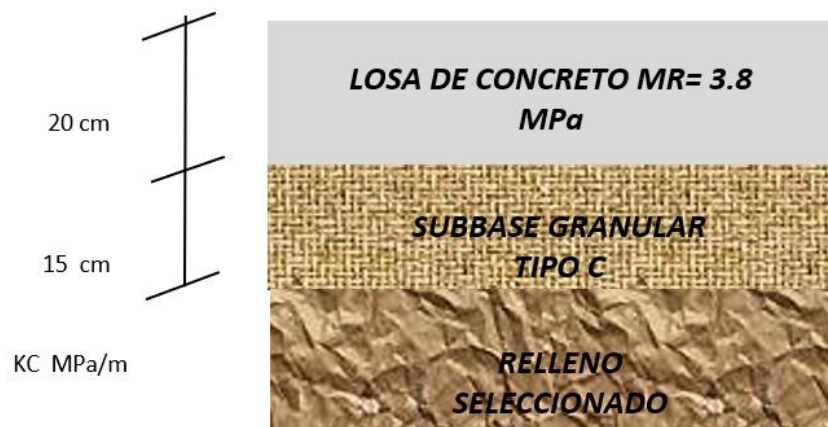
Diseño Estructural Pavimento Concreto Rígido
